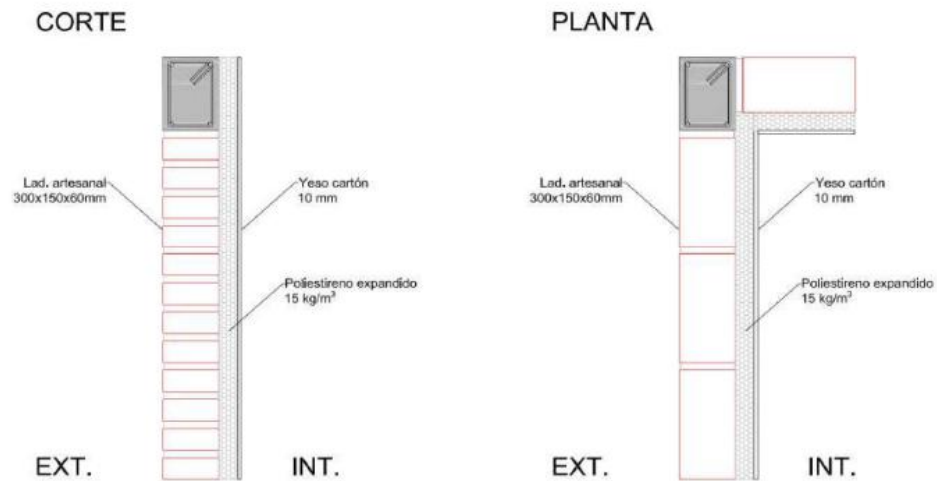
Detalle constructivo de solución térmica para muros de albañilería
